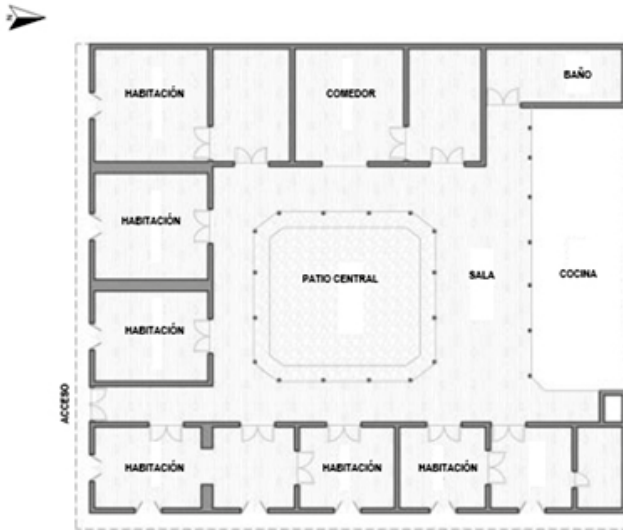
Planta nivel 1 Casa Toros Ceballos.
